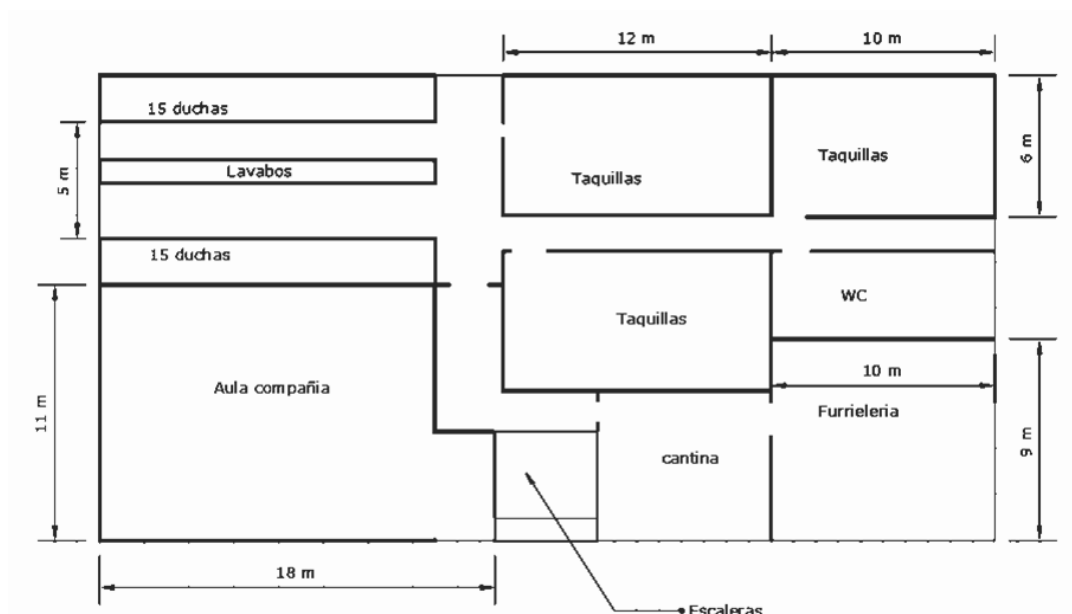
Plano plantas 1 y 2. Fuente: Elaboración propia.
